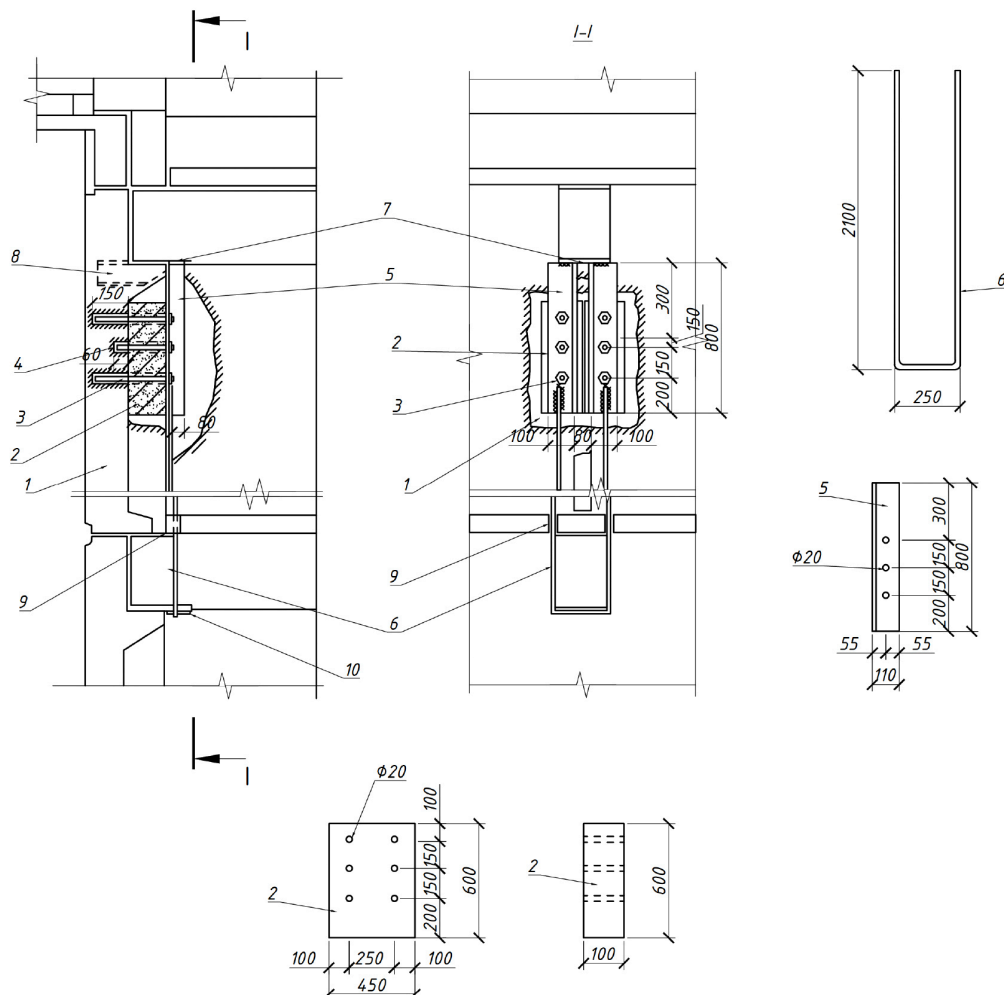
Схема подвески прогонов на стеновые панели. Разрез: 1 – ребро железобетонного каркаса панели; 2 – несущая железобетонная накладка; 3 – анкерный болт М16; 4 – полимерный клей; 5 – опорно-прижимной уголок; 6 – подвеска на арматурной стали  $d = 16$  мм; 7 – закладная деталь существующего прогона; 8 – существующий опорный столик; 9 – отверстие  $d = 25$  мм в существующем перекрытии; 10 – стальная подкладка
